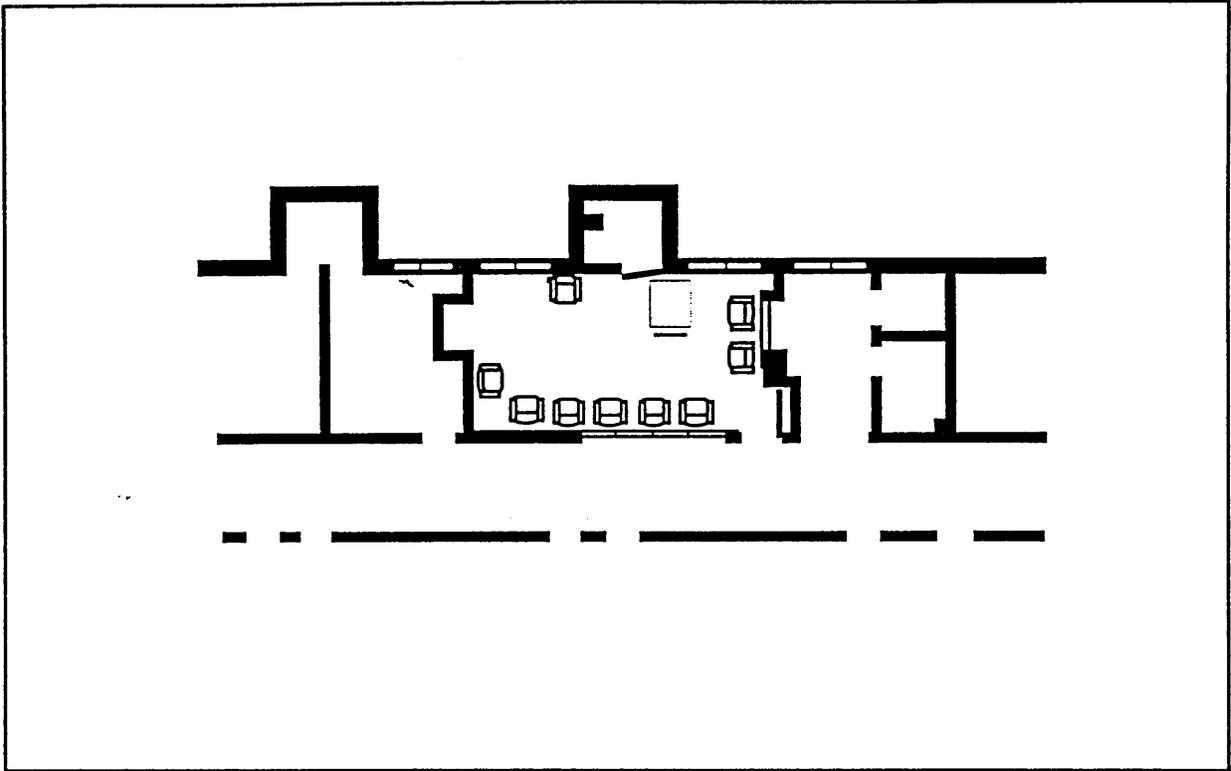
Aménagement du salon du rez-de-chaussée
